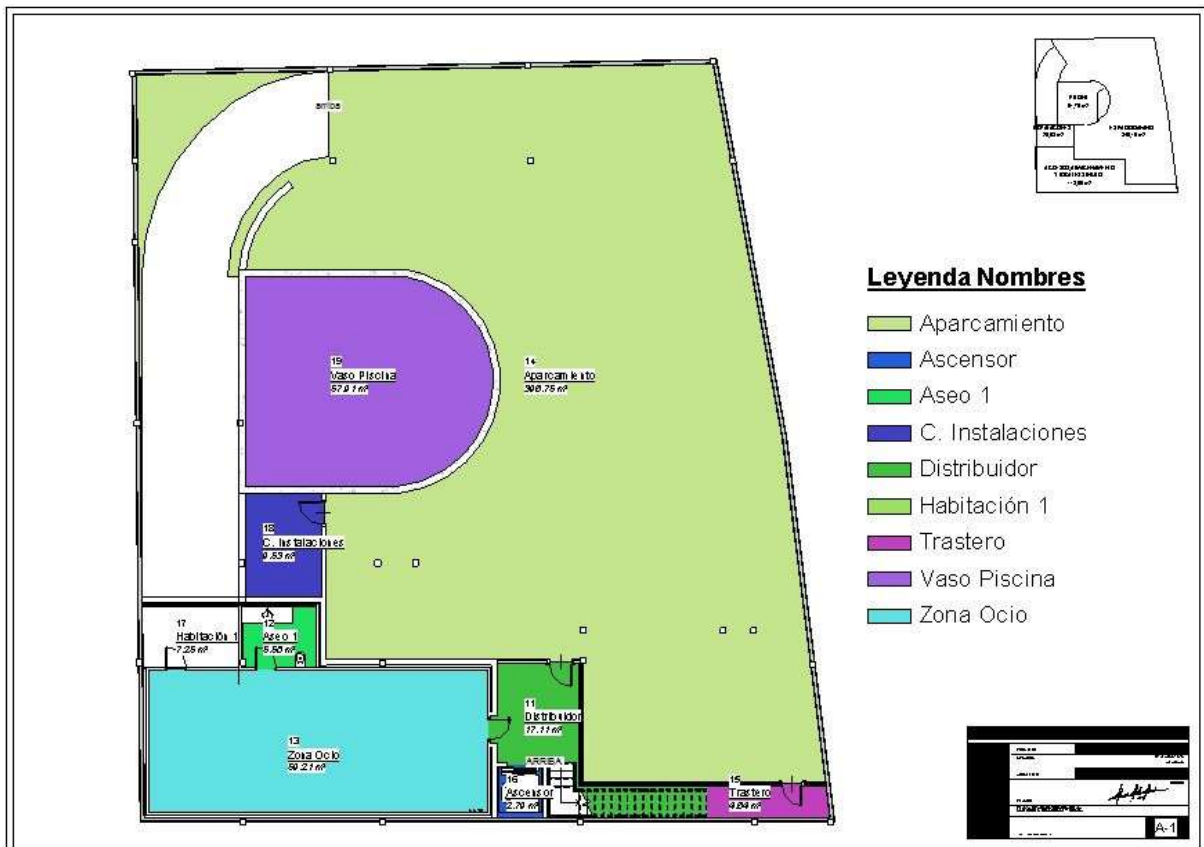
Plano de Superficies. Planta Sótano. Fuente propia. 2016
